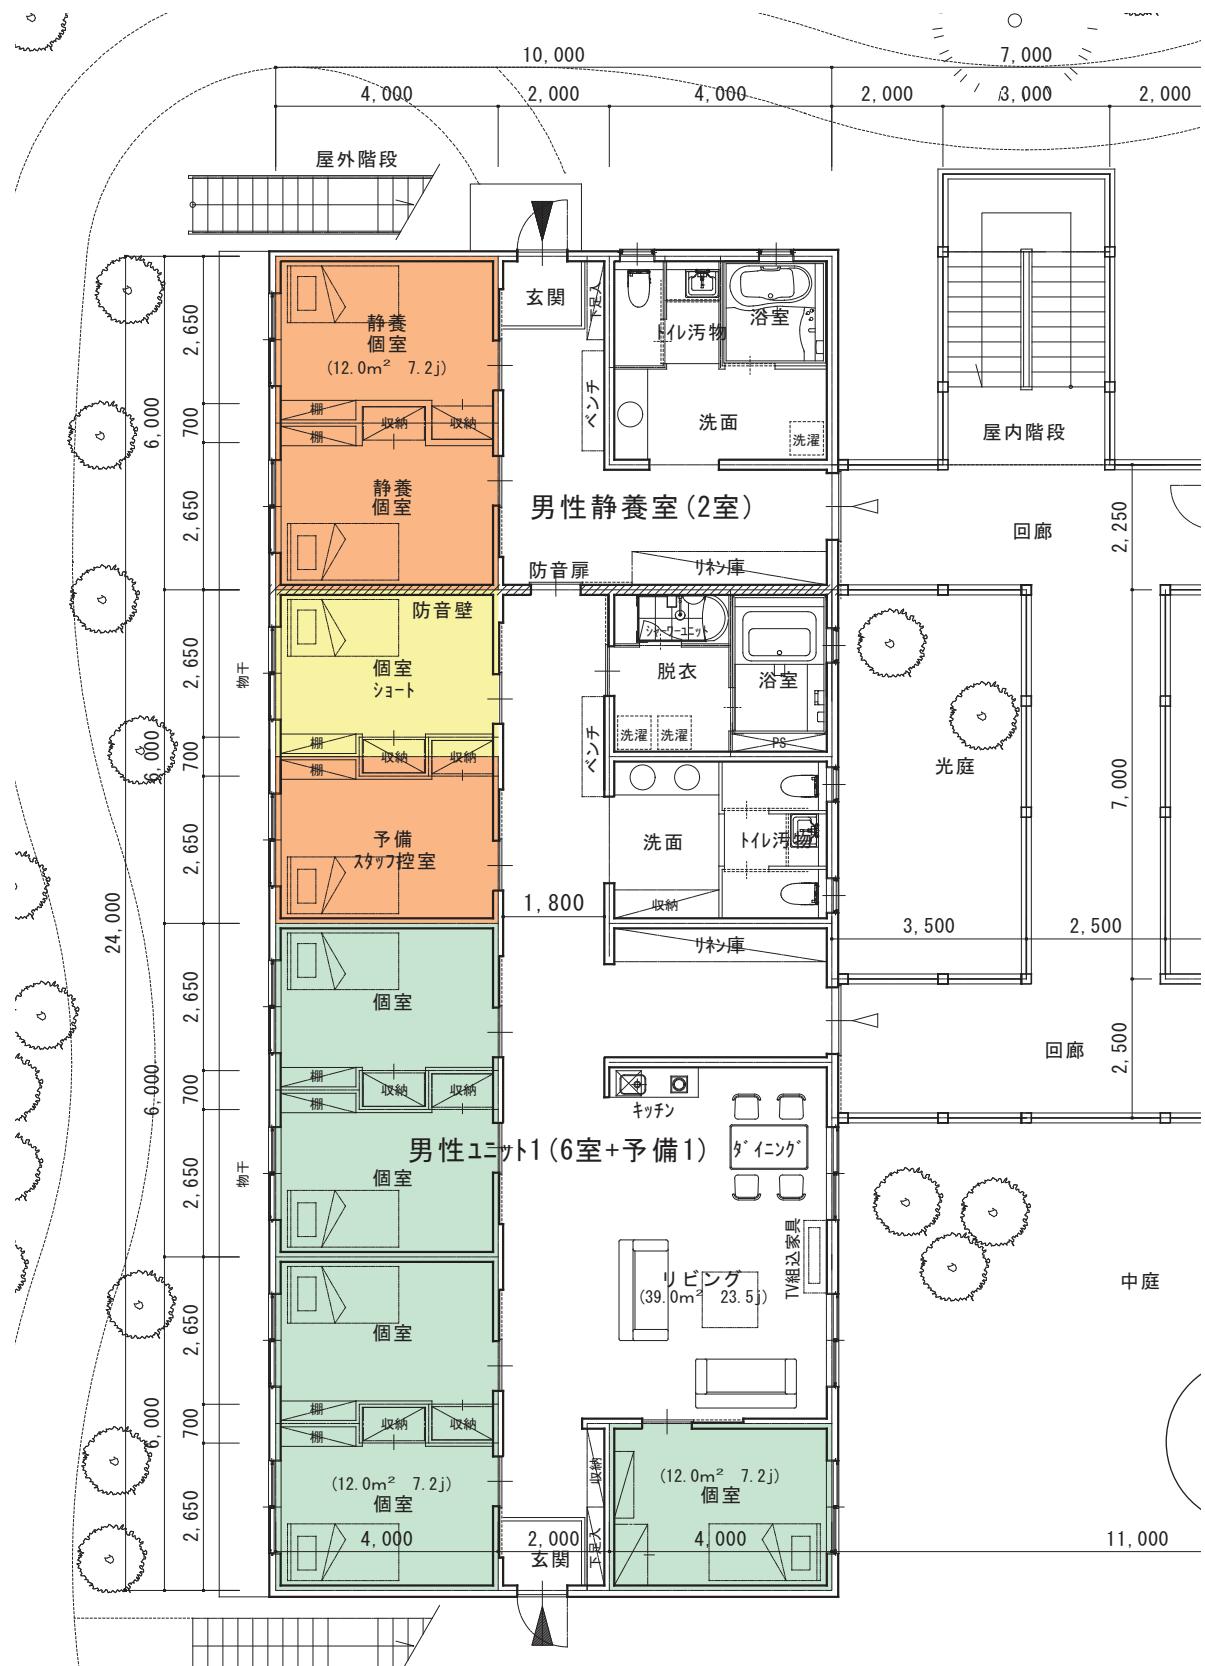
都市型生活施設のユニット及び静養室（1階平面図）
